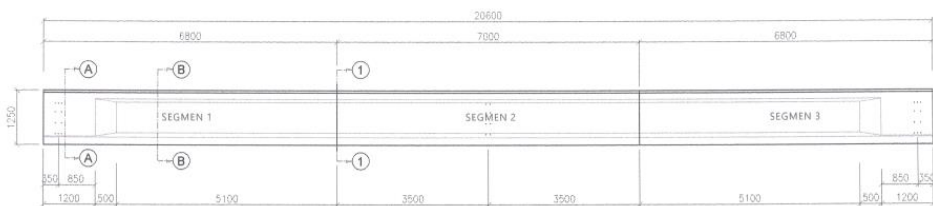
Tampak Atas Girder A1-P1 Bentang 40 m
